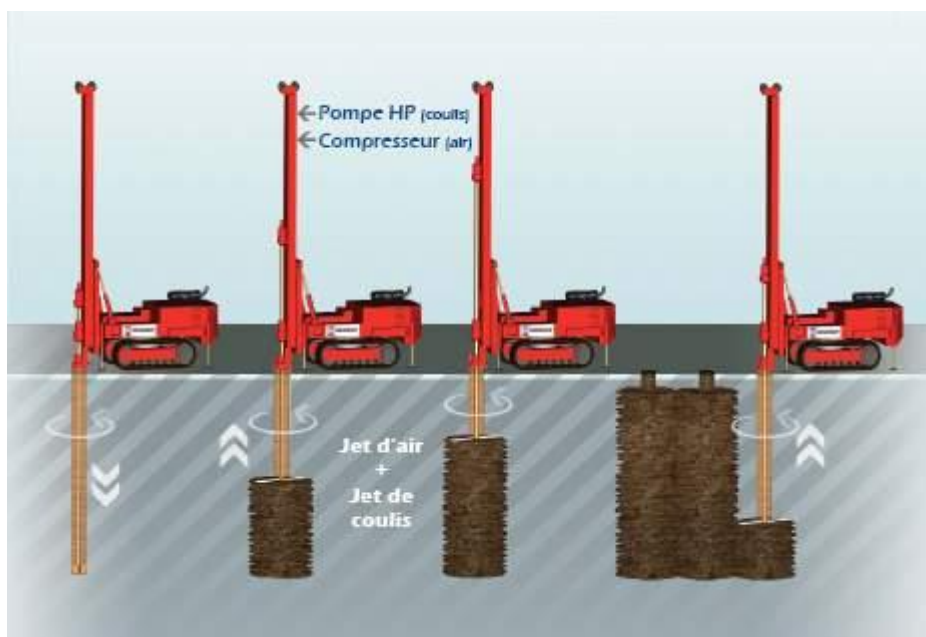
Schema di funzionamento di un impianto a Jet-grouting
